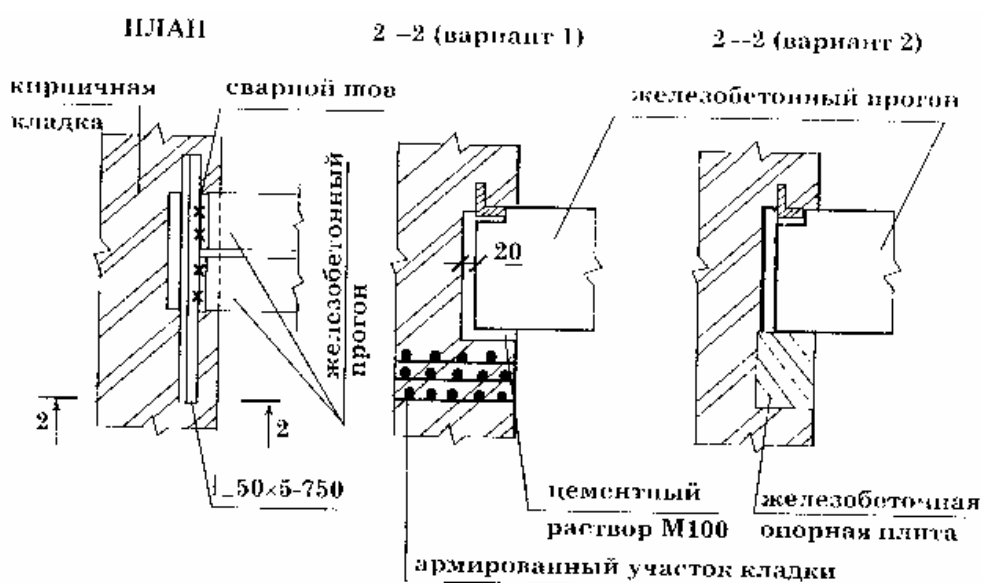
Опирание прогона на кирпичный столб (стену) или на армированные ряды кладки
